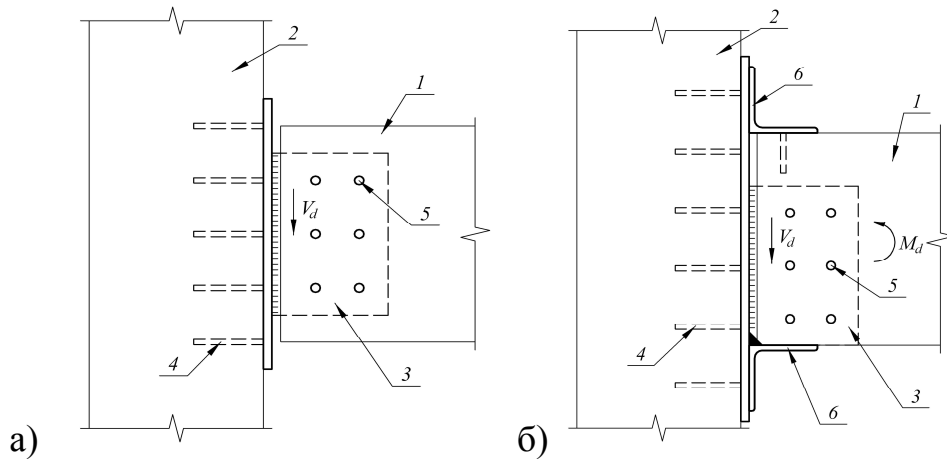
Загальний вигляд конструкції вузлів сполучення клеєної дерев'яної балки та колони: а) шарнірний; б) жорсткий; 1 – балка; 2 – колона; 3-Т-подібний зварний елемент; 4, 5 – болти; 6 - кутники
